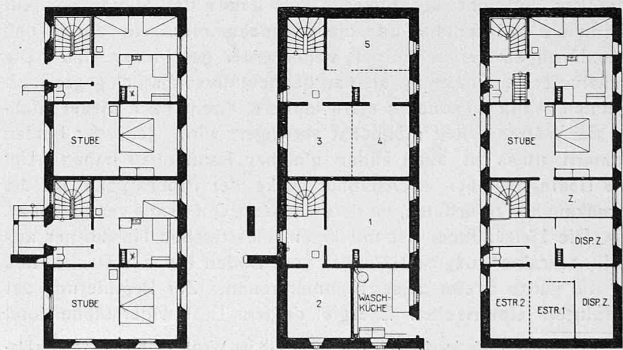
Grundrisse vom Erdgeschoss, Keller und Dachstock 1:400 des Fünffamilien-Dienstwohnhauses der Rhät. Bahn in Filisur.
